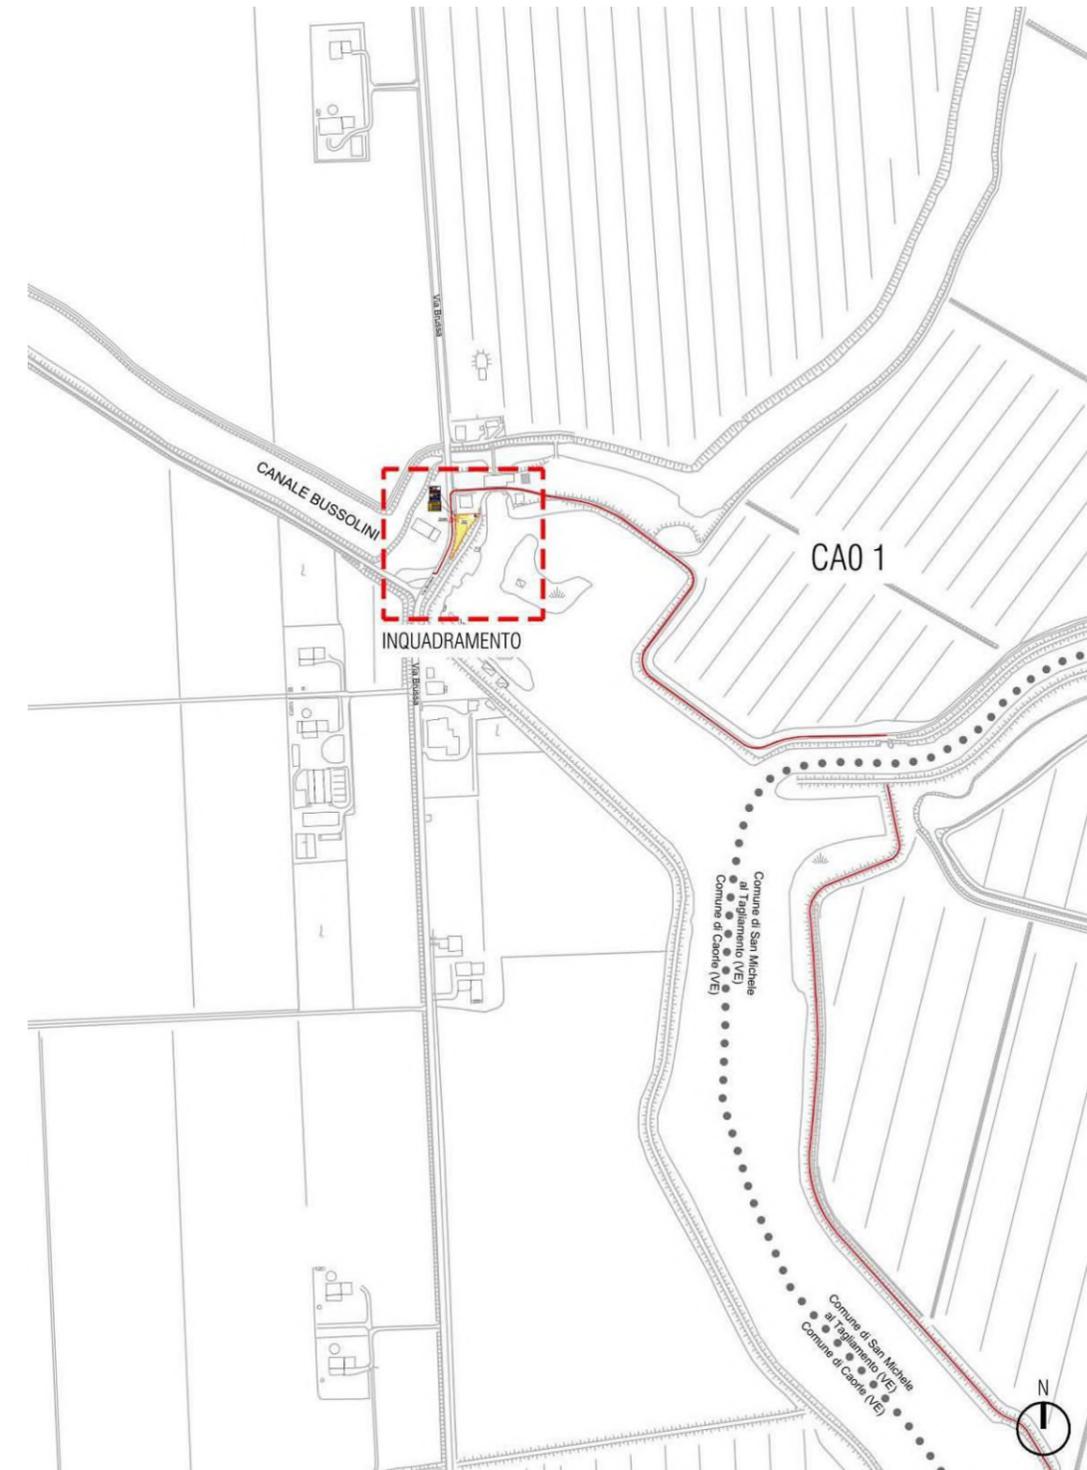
Individuazione area di cantiere nell'ambito della Brusca (Caorle).
